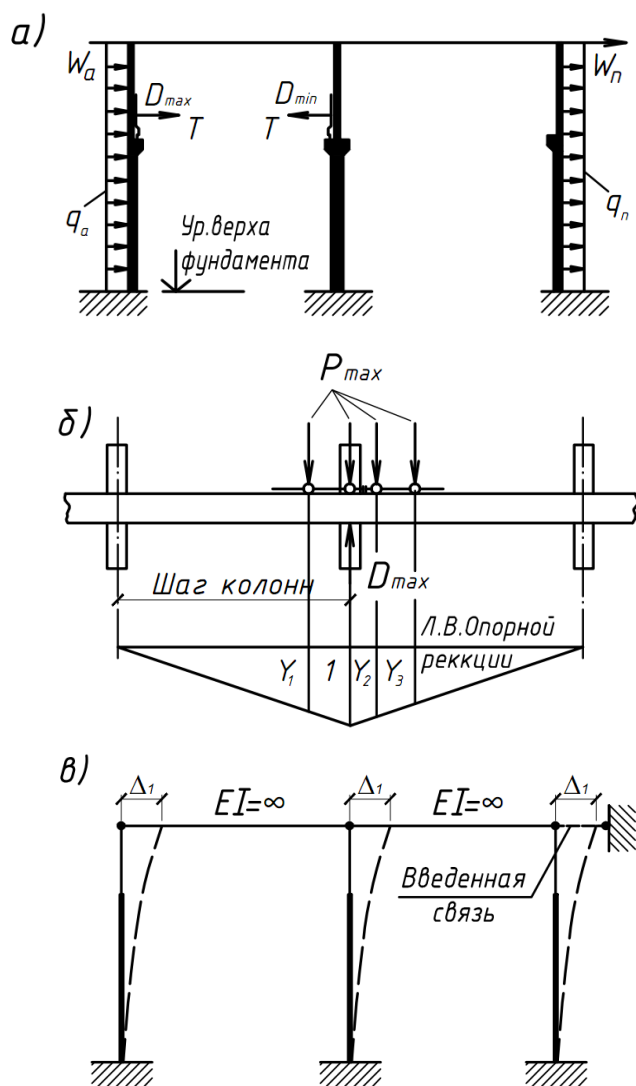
Расчетная схема одноэтажного каркасного здания: а – поперечная рама; б – элемент продольного разреза; в – основная система метода перемещений
